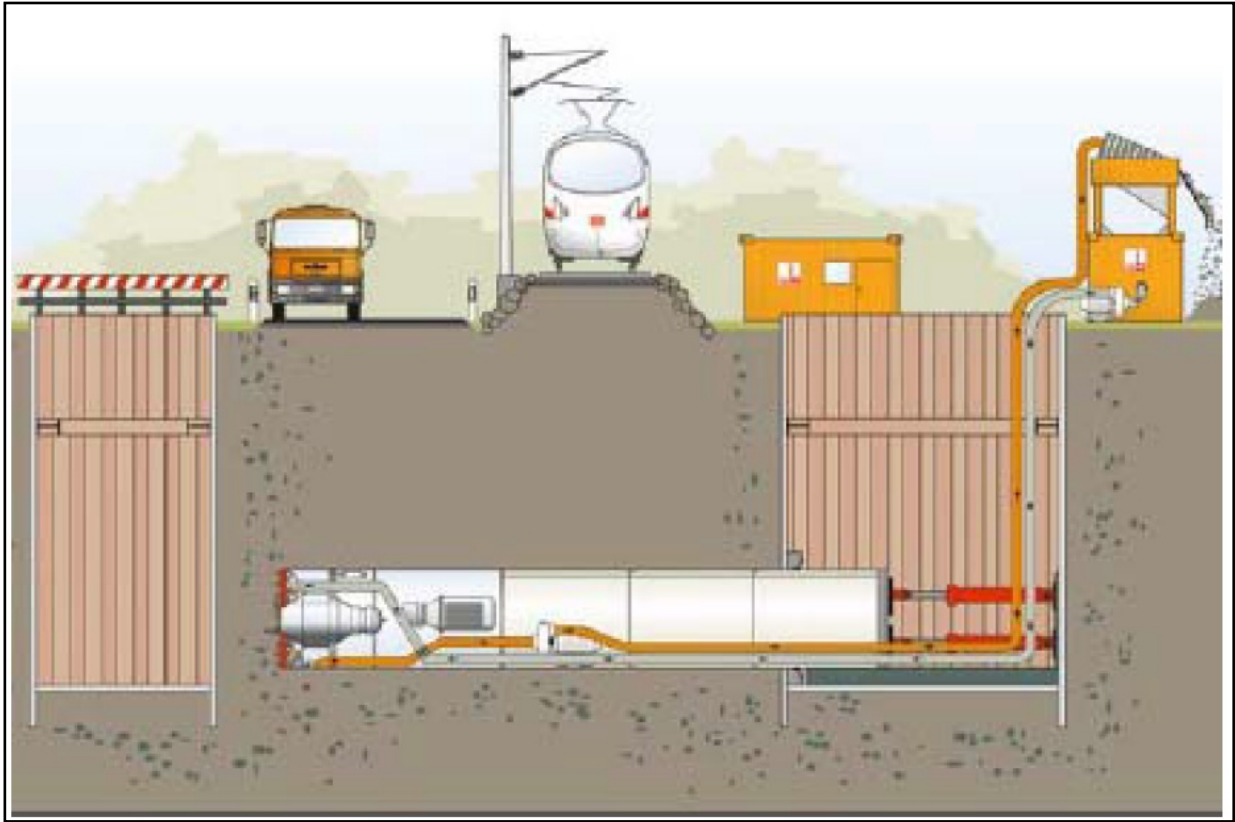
Mikrotunnelbau mit Spülförderung, schematische Darstellung
